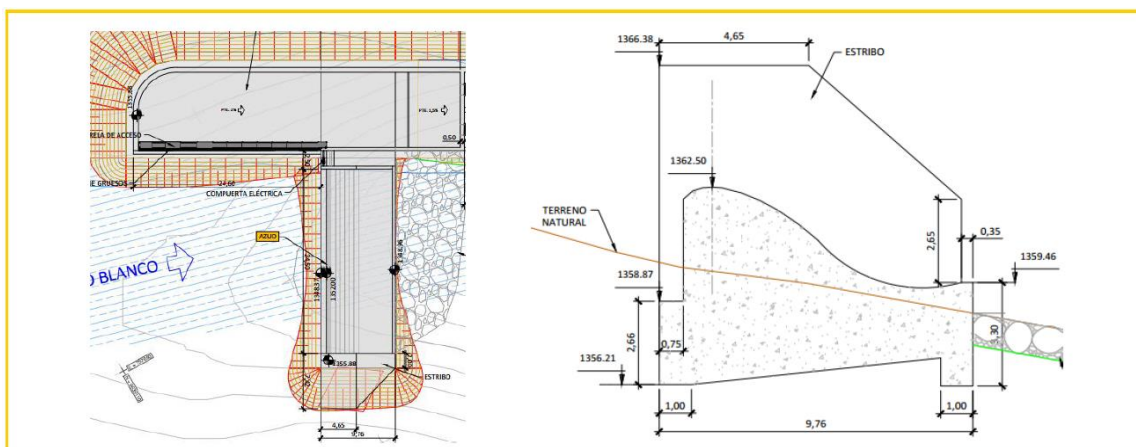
Planta y Sección Tipo del Azud a Instalarse en el Río Blanco
